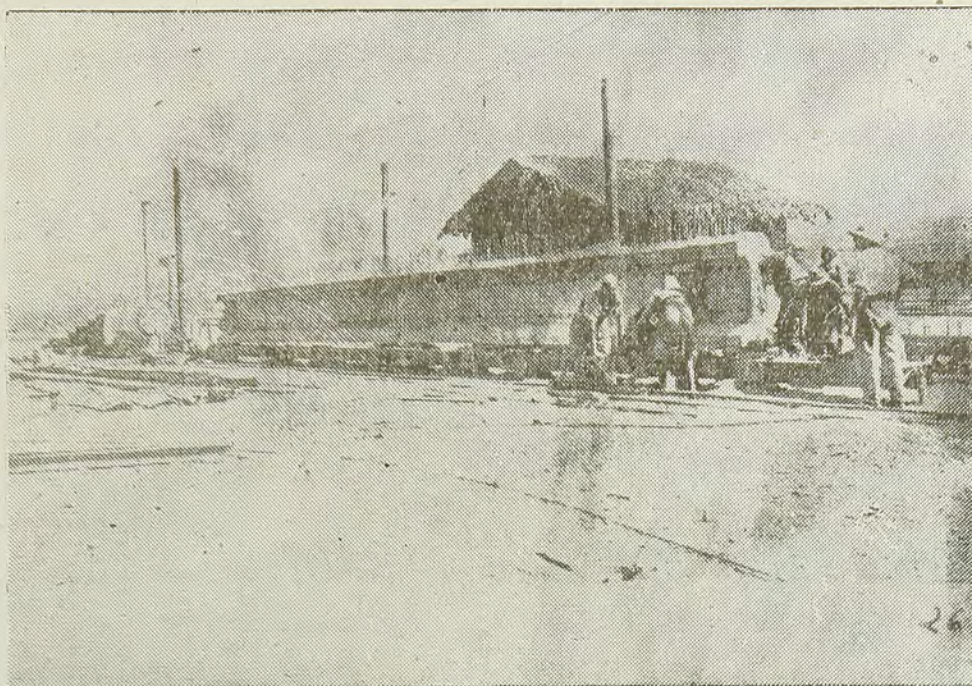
Una viga de cables sin adherencia, con estribos en tensión.
